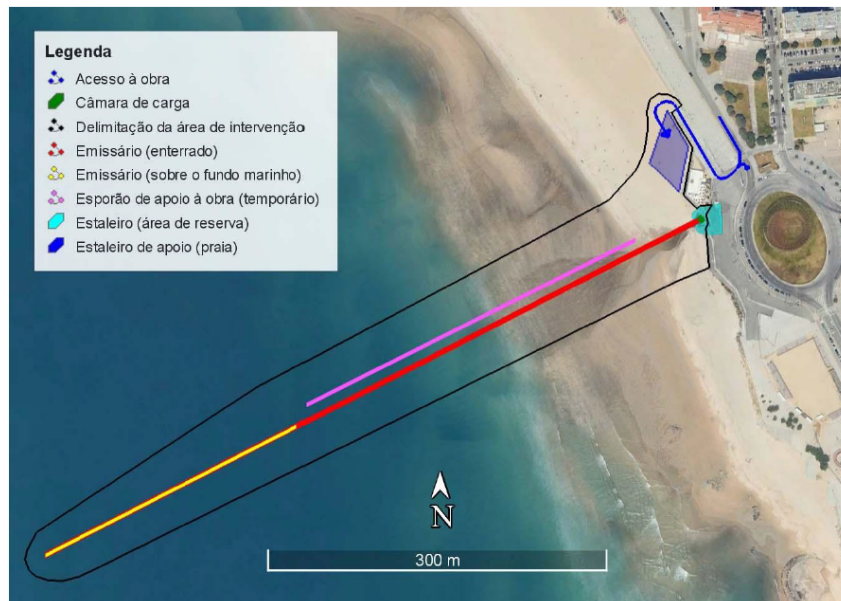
Esquema do Projeto na fase de construção (Fonte: Pedido de Verificação da Aplicabilidade do Regime Jurídico de AIA)
